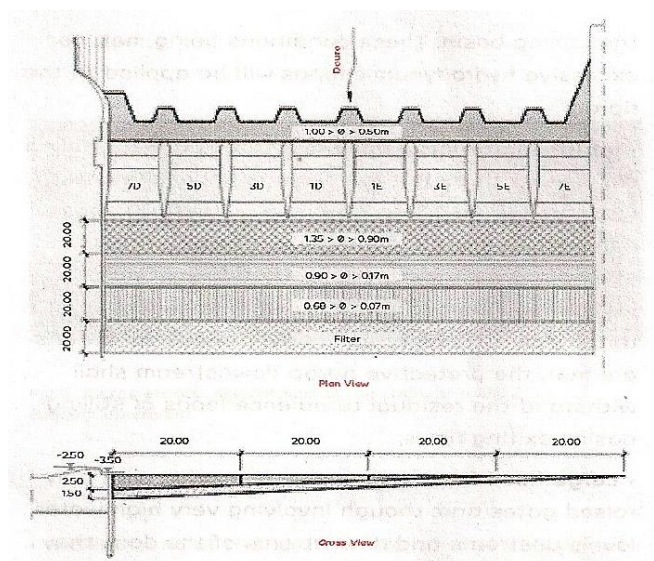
Esquema em planta (acima) e corte (baixo) das medidas adotadas para a proteção de jusante aquando o projeto inicial [5]
